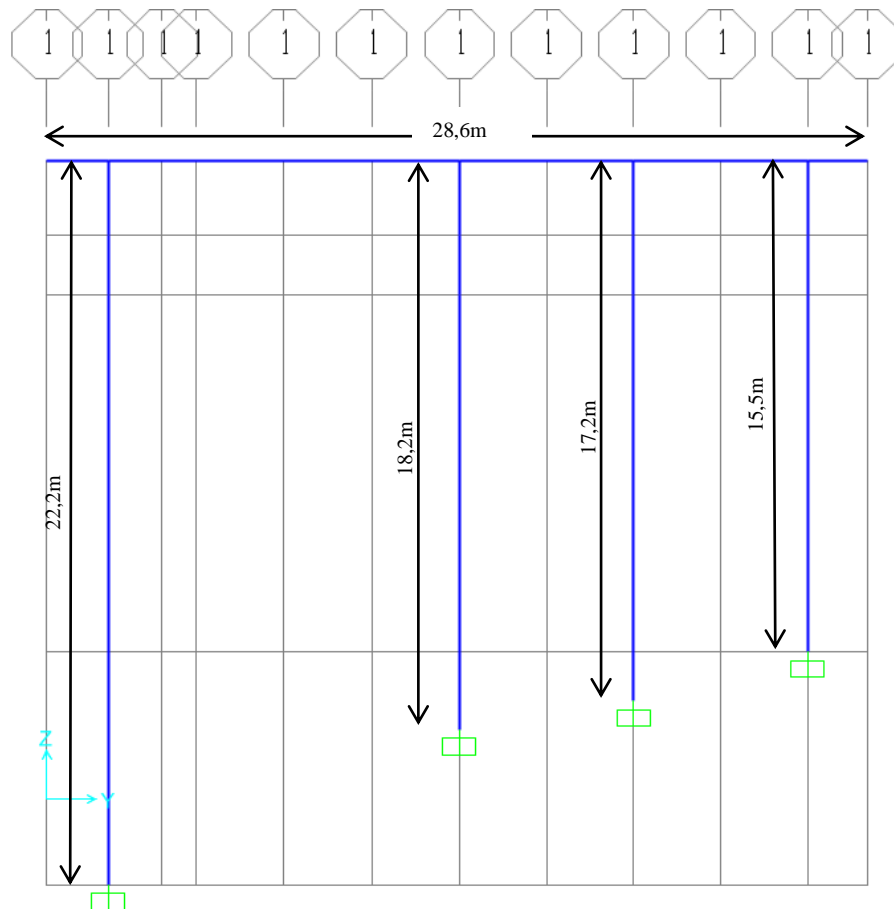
Vista en elevación del plano 1 de geometría, paralelo a plano Y-Vertical.
